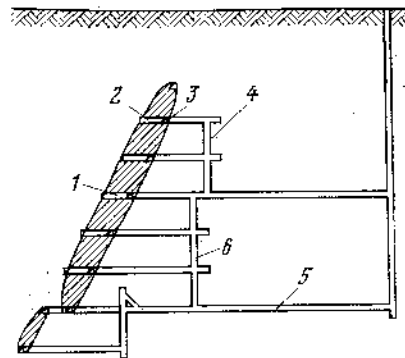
Схема вскрытия вертикальным стволом с групповыми квершлагами
